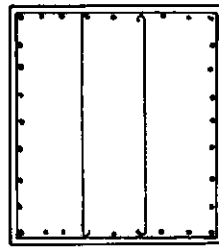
DETALHE DA ARMADURA DE PROTENSÃO
